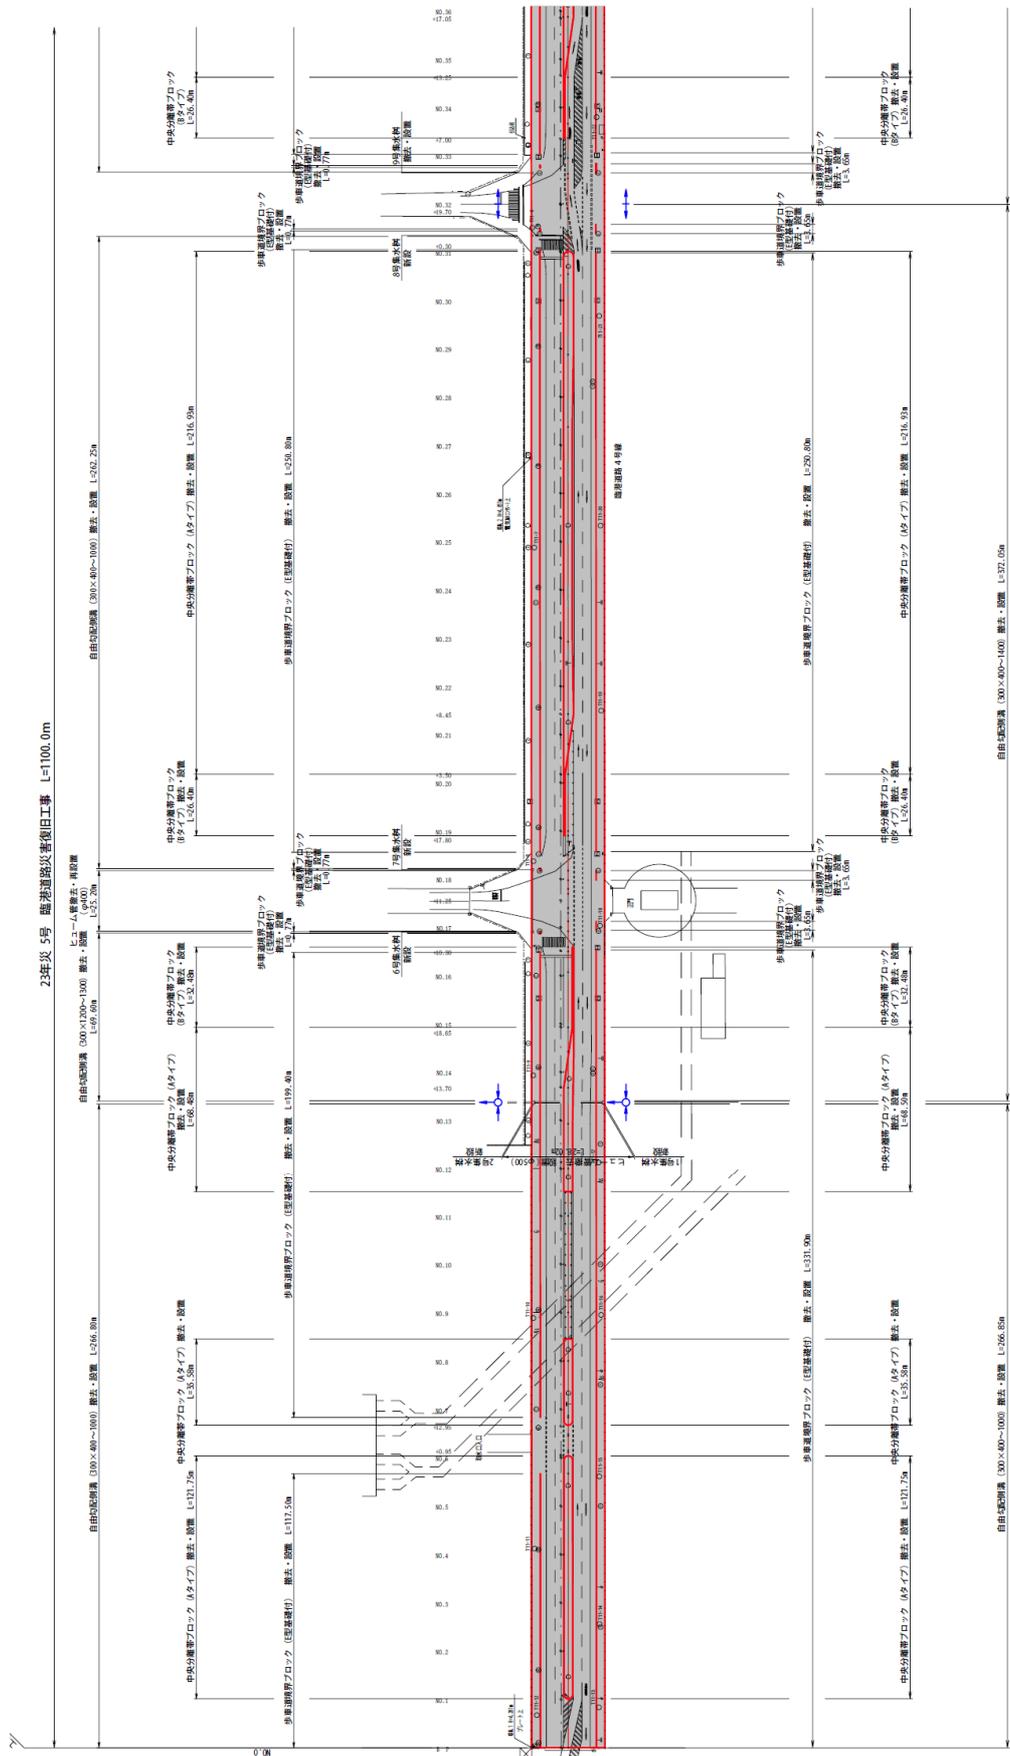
344 No.8 常陸那珂港区_臨港道路4号線の平面図①(復旧後)
